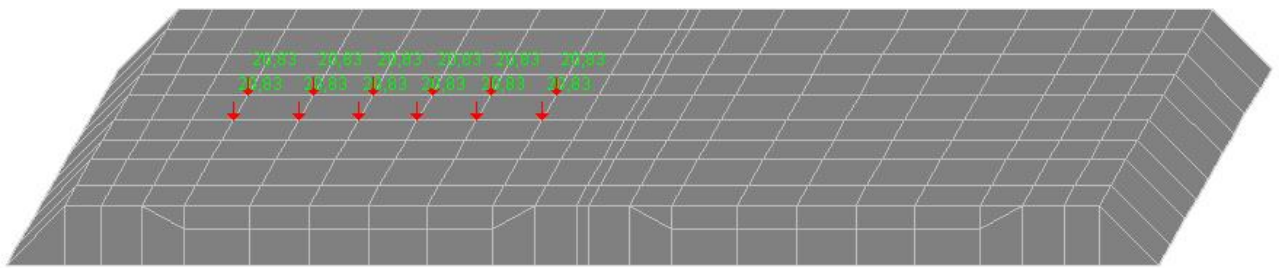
Розташування навантажень на верхню будову колії (ВБК)
